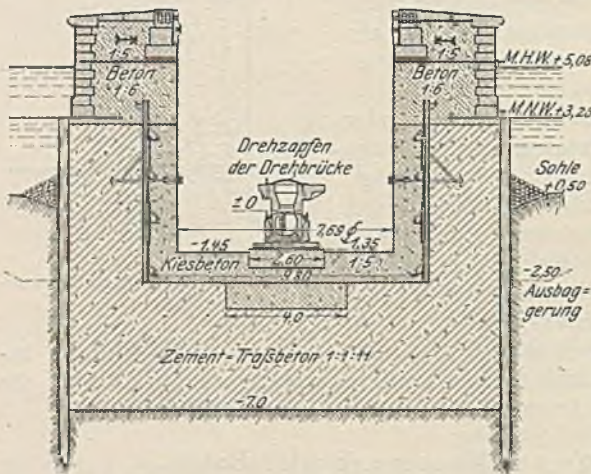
Beispiel einer Gründung auf Schüttbeton unter Wasser.
